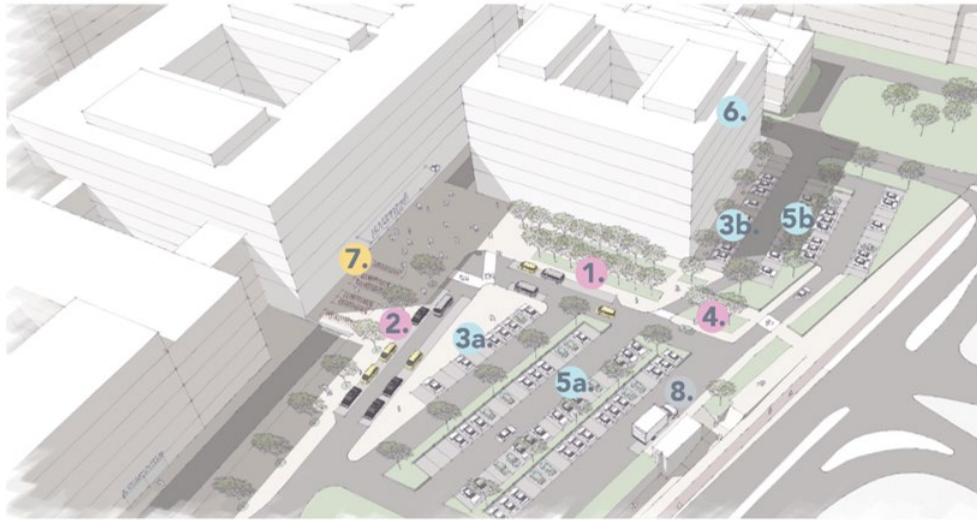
Entrézon enligt planförslagets illustrationsplan.
